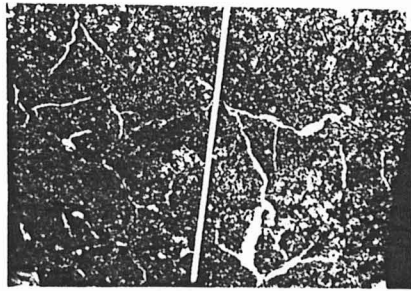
Concreto do vertedouro da barragem de Joanes(BA) com padrão de fissuramento e exsudação de gel nas fissuras, decorrente de reação álcali-silicato.
